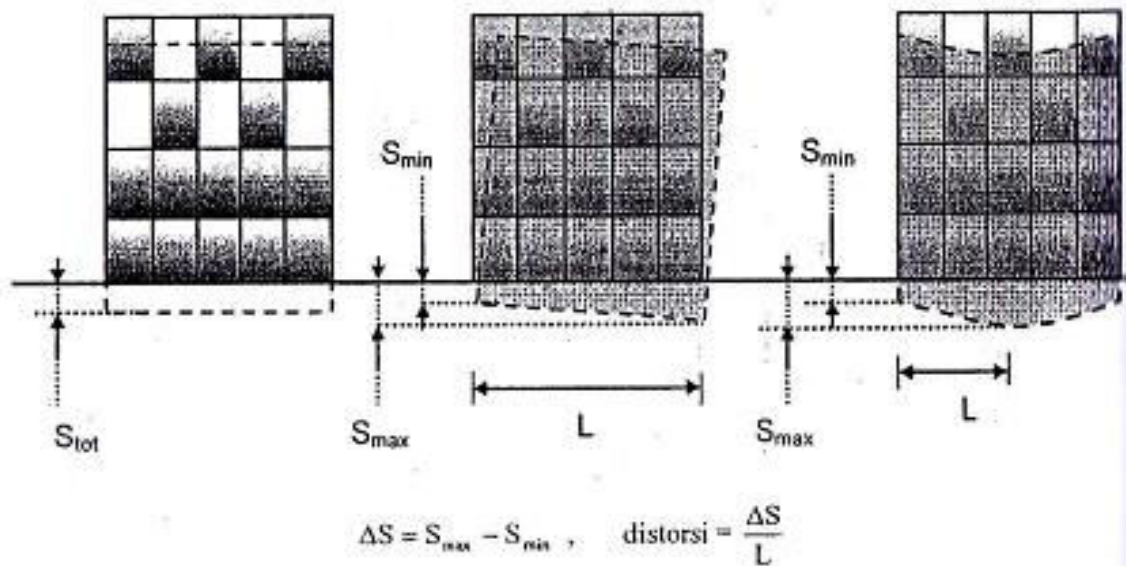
Tampak Penurunan pada Bangunan Eksisting
